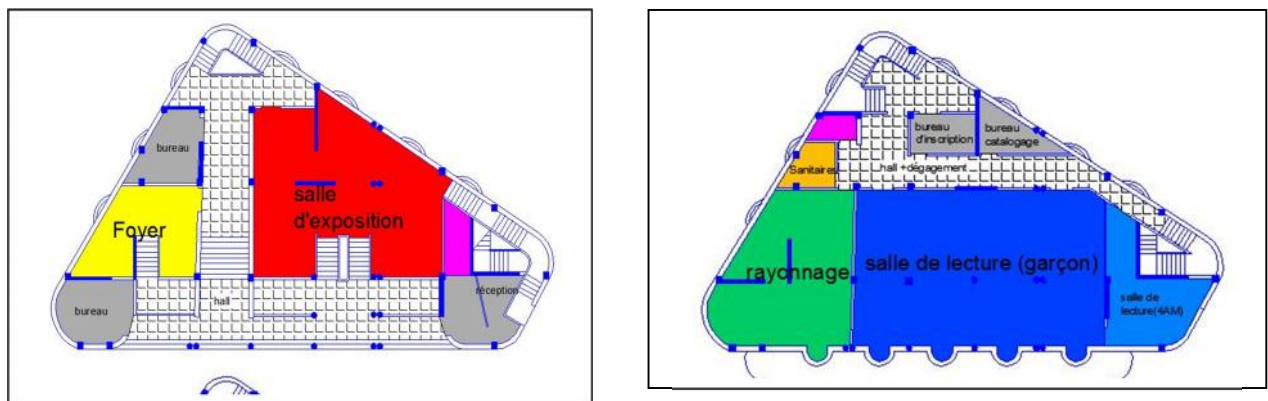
De gauche à droite le plan de RDC et le plan de premier étage
